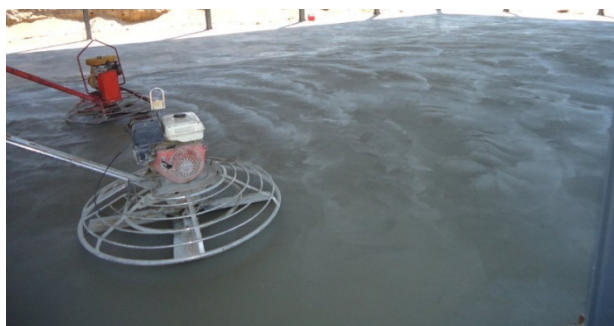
Exemplo de pavimento em betão com acabamento afagado mecanicamente a executar nas garagens
